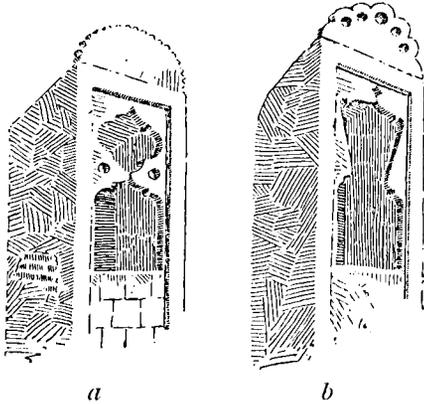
Badgirköpfe, Liwanhaus, Bagdad.
